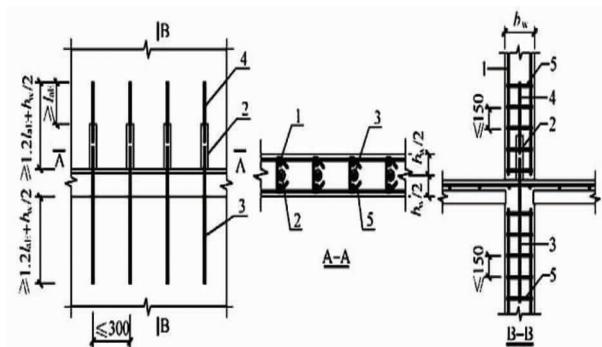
坚向分布钢筋单排灌浆套筒连接构造示意
